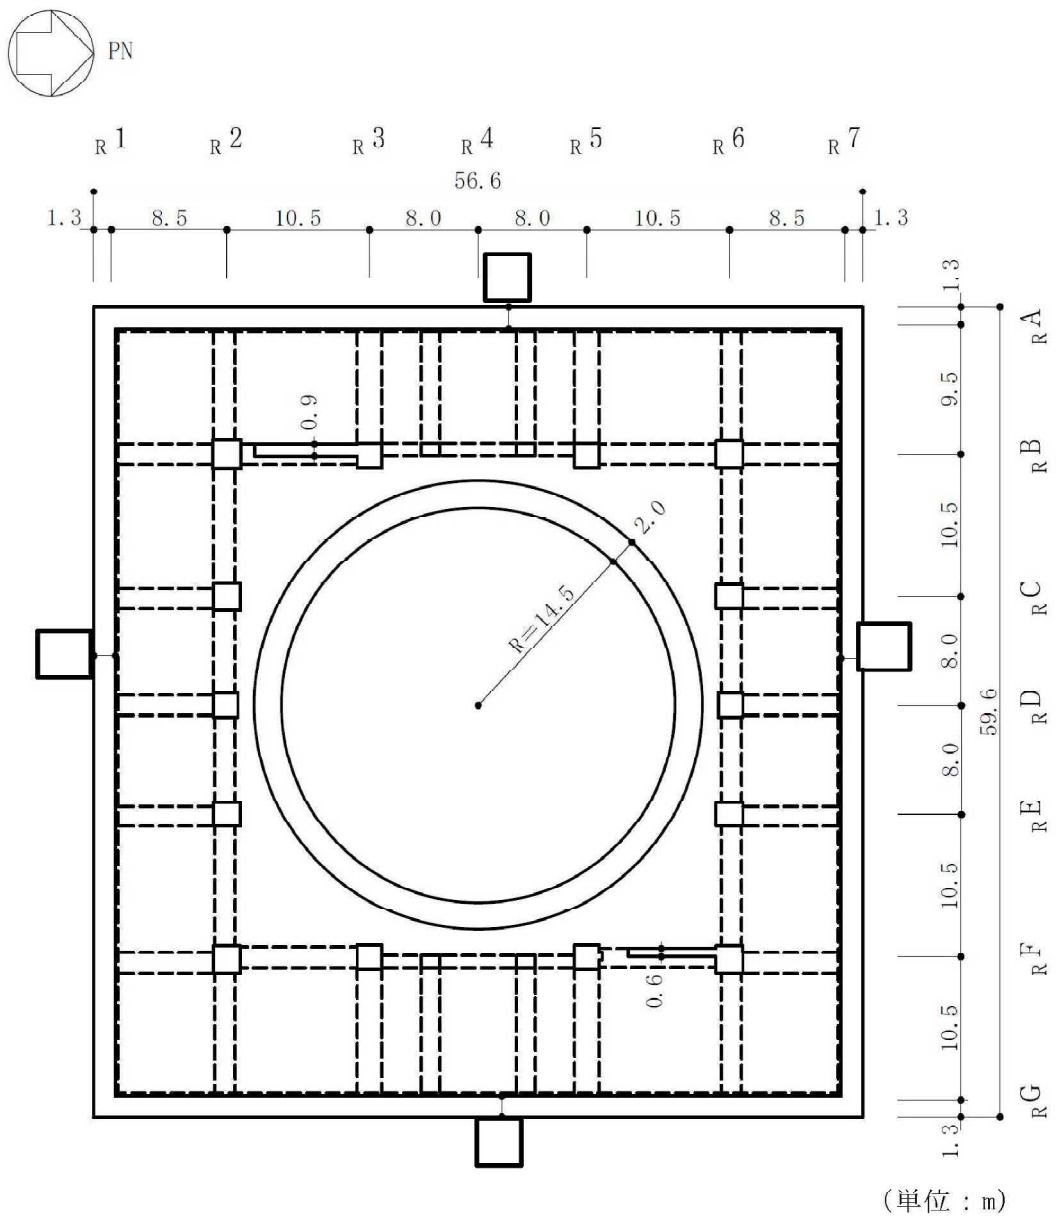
原子炉建屋の概略平面図 (B2F, T.M.S.L. - 1.7m) (2/9)
